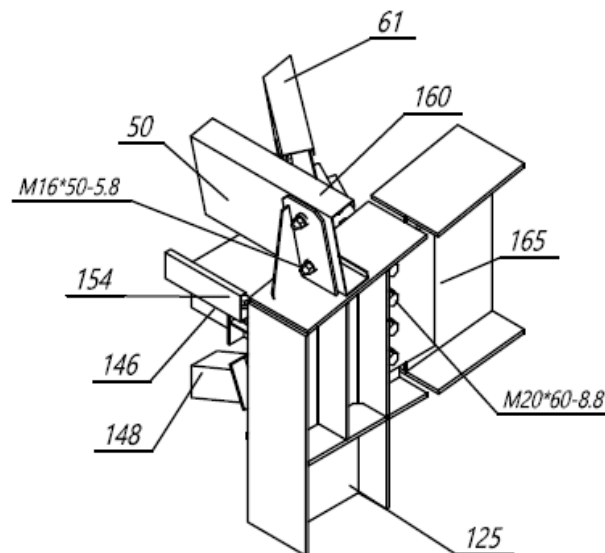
Узел соединения ферм покрытия с несущими колоннами
